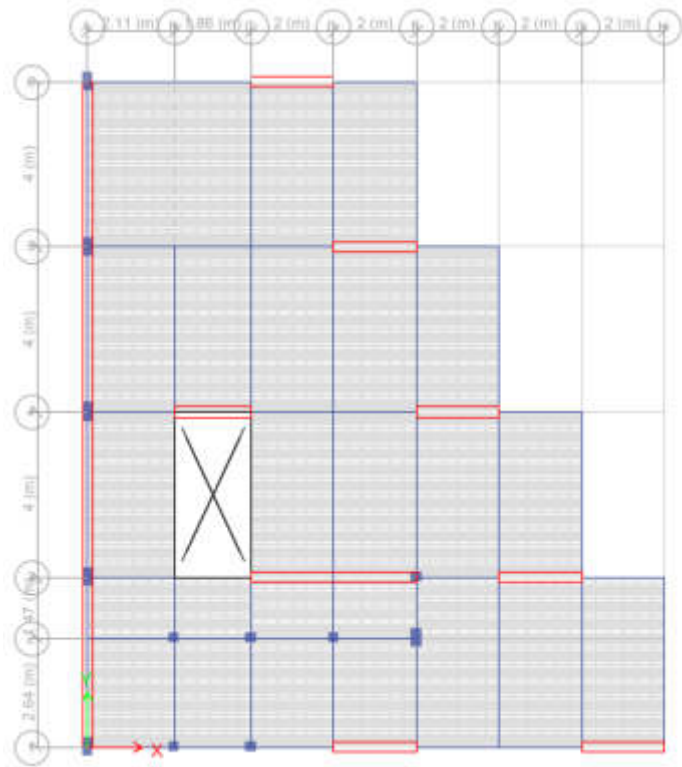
Planta típica 1º y 2º nivel, modelo en Etabs 16.2.1
